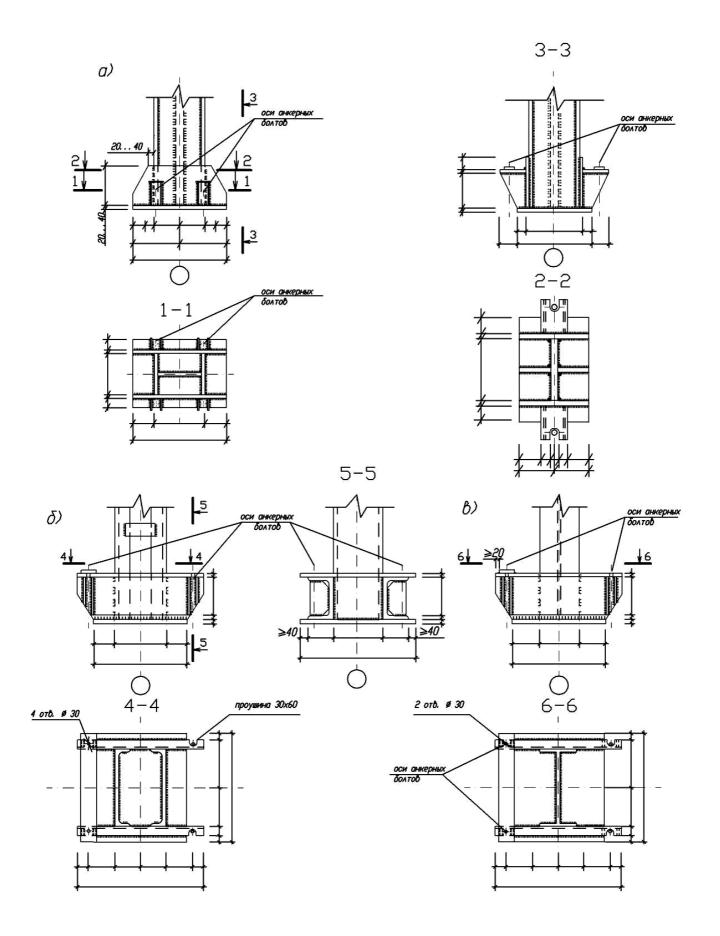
Базы колонн при жёстком сопряжении с фундаментом
